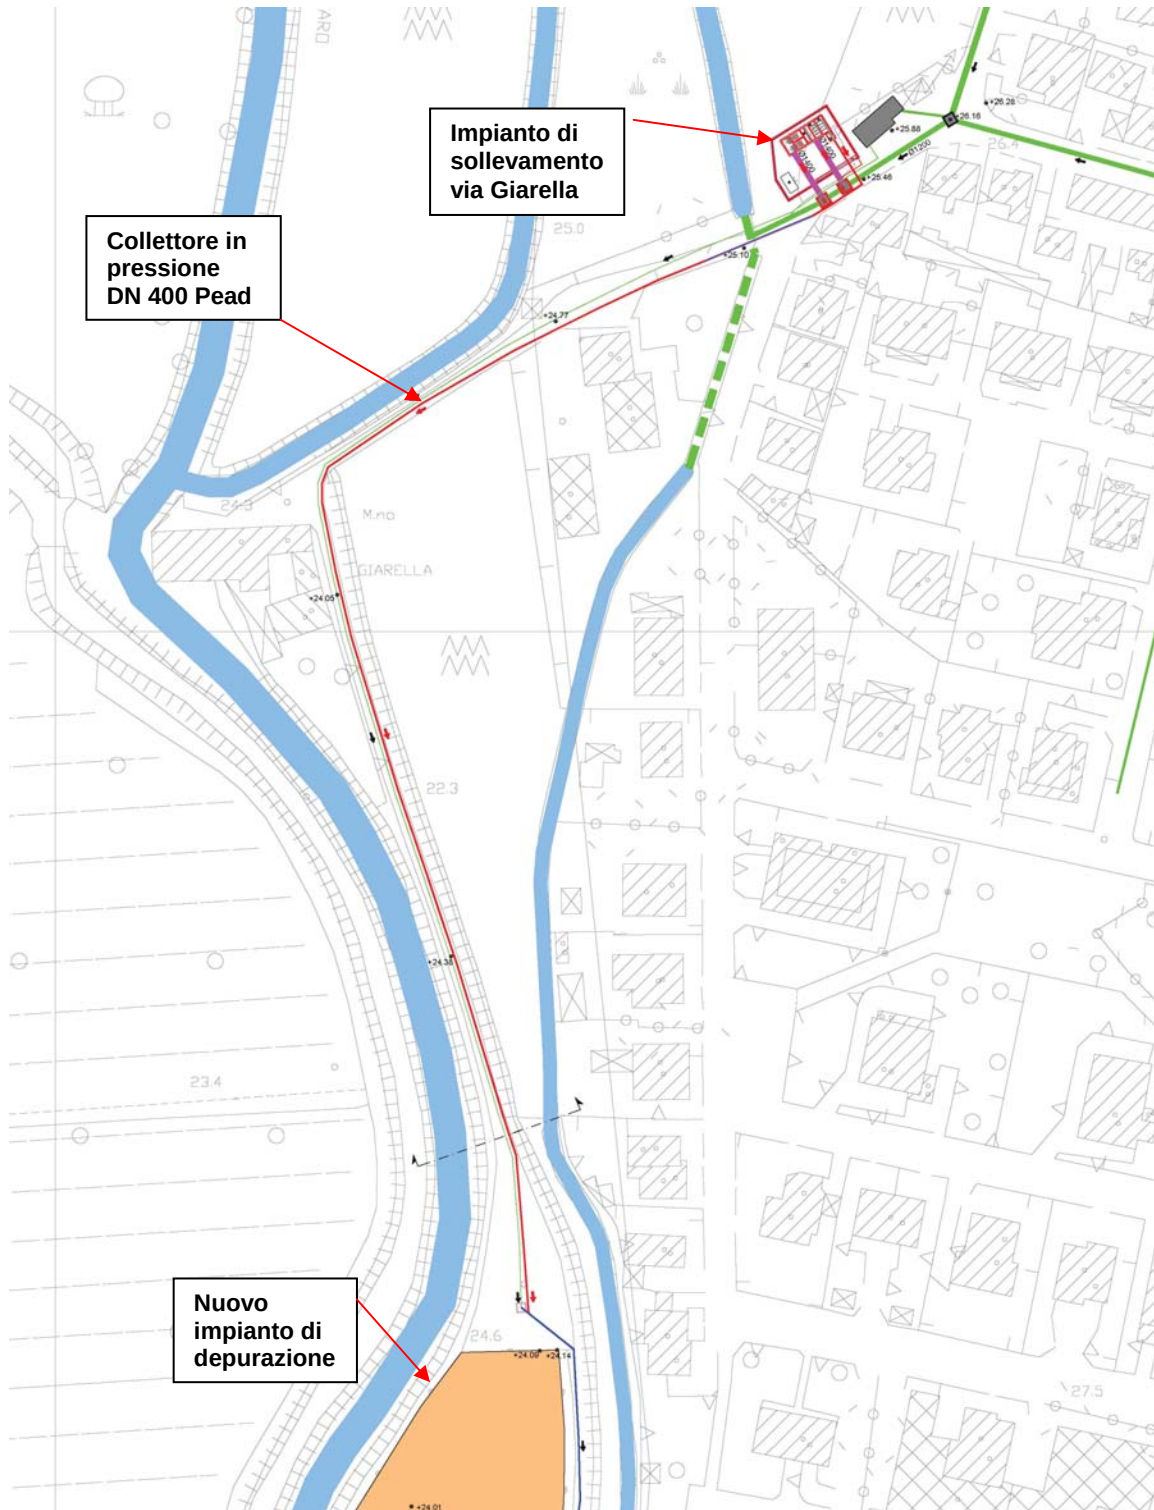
Estratto palnimetria su base CTR con opere di progetto
